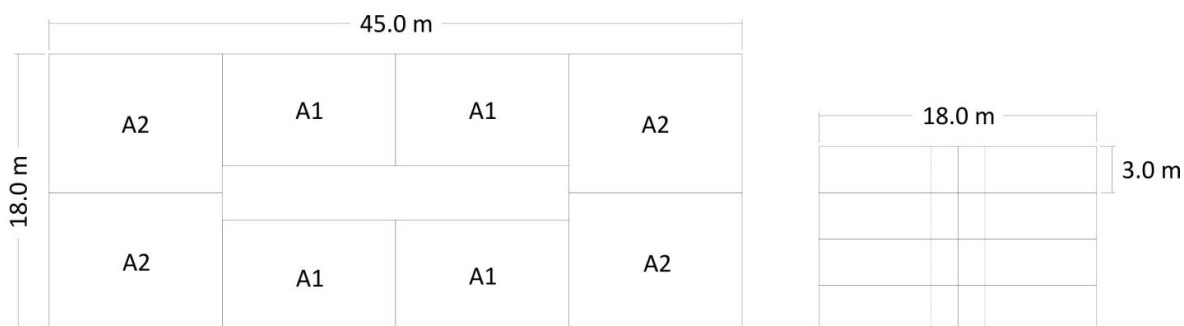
Archétype 1, plan d'étage (gauche) et élévation (droite)
